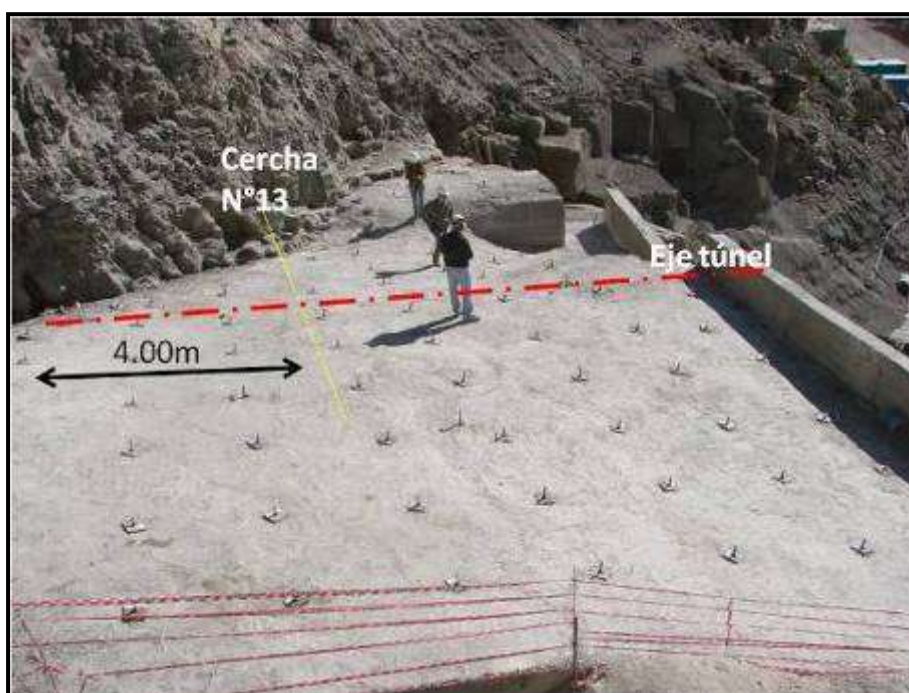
Vista de la berma una vez construida la losa, donde se observan los anclajes que cosen desde el exterior los bloques de areniscas.
